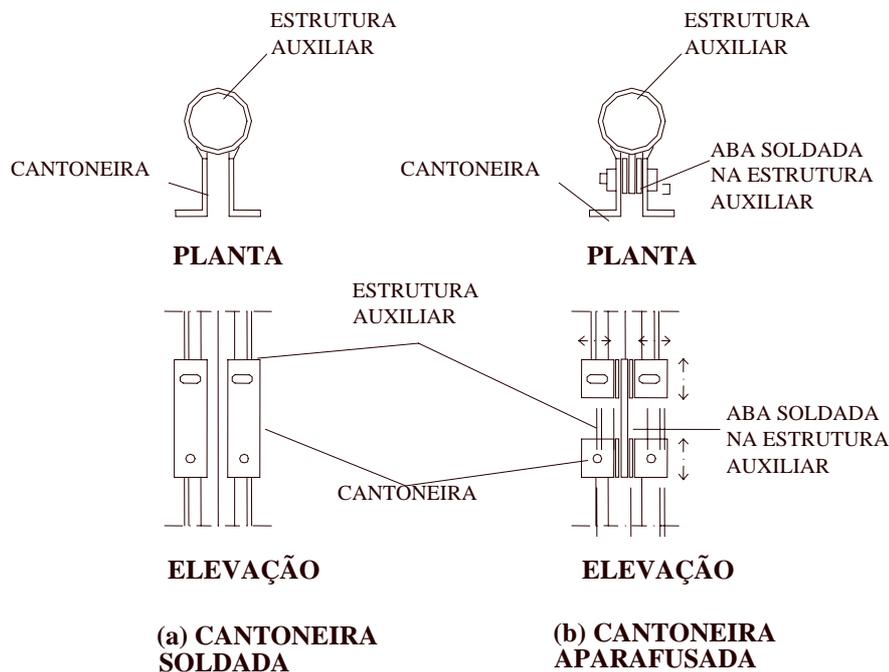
Arranjo de cantoneiras para fixação do painel.
